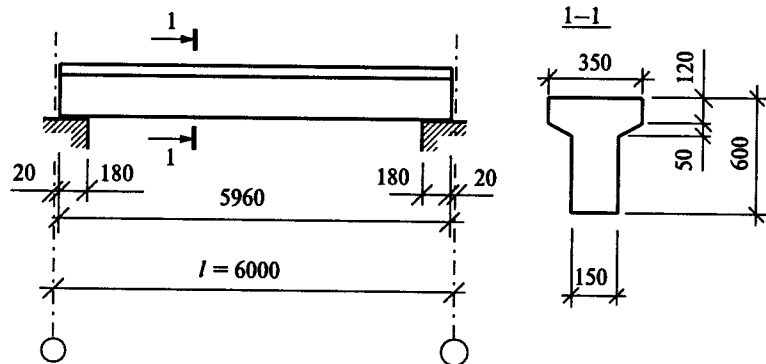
Размеры балки и схема ее опирания на стены — к примеру 7.10
